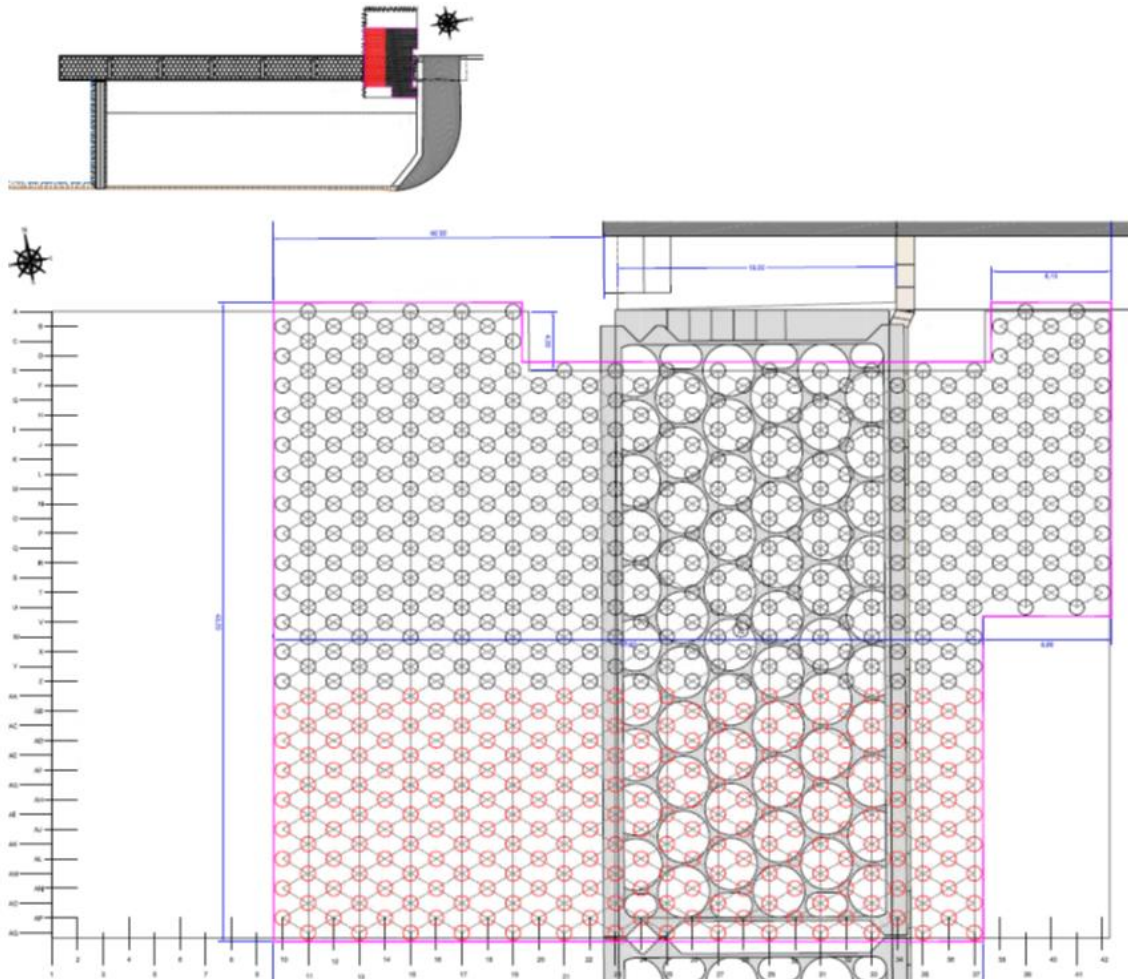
Fondeo del cajón sobre las columnas de grava.
